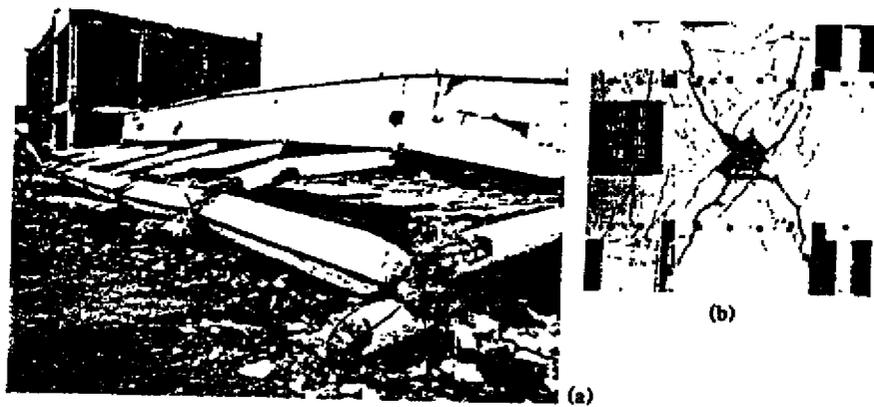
Falla de uniones viga-columna en (a) el sismo de El Asnam y (b) en un espécimen de laboratorio
